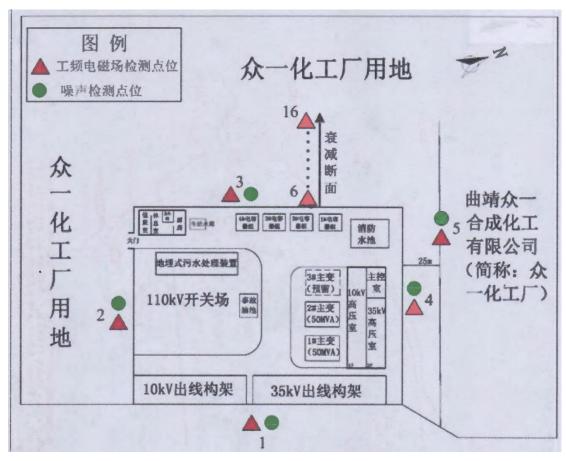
110kV 新田(岳东营)变电站总平面布置及监测点位布置图
